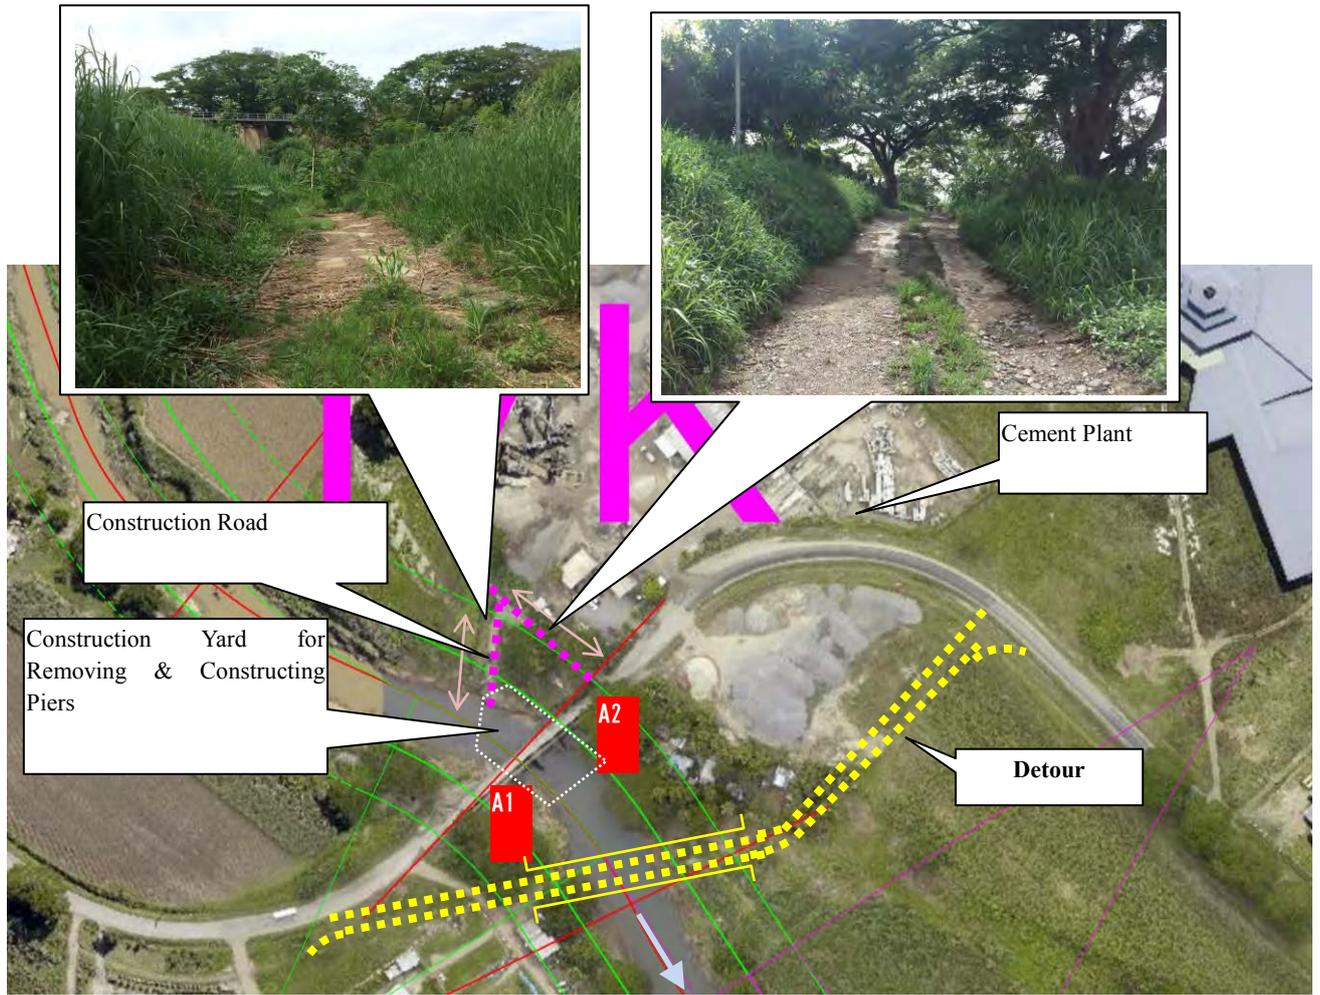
工事用進入路計画 (Old Queens Road Bridge)
